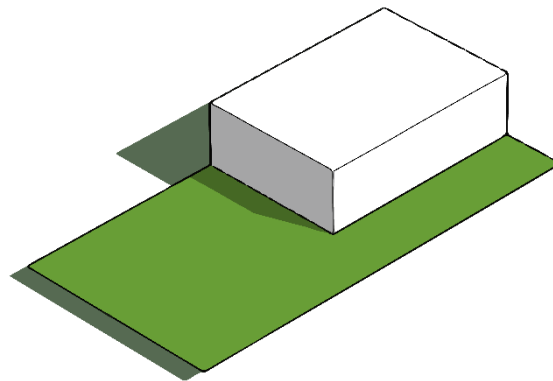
Construcción módulo básica planta baja. Elaboración Propia 2019.
